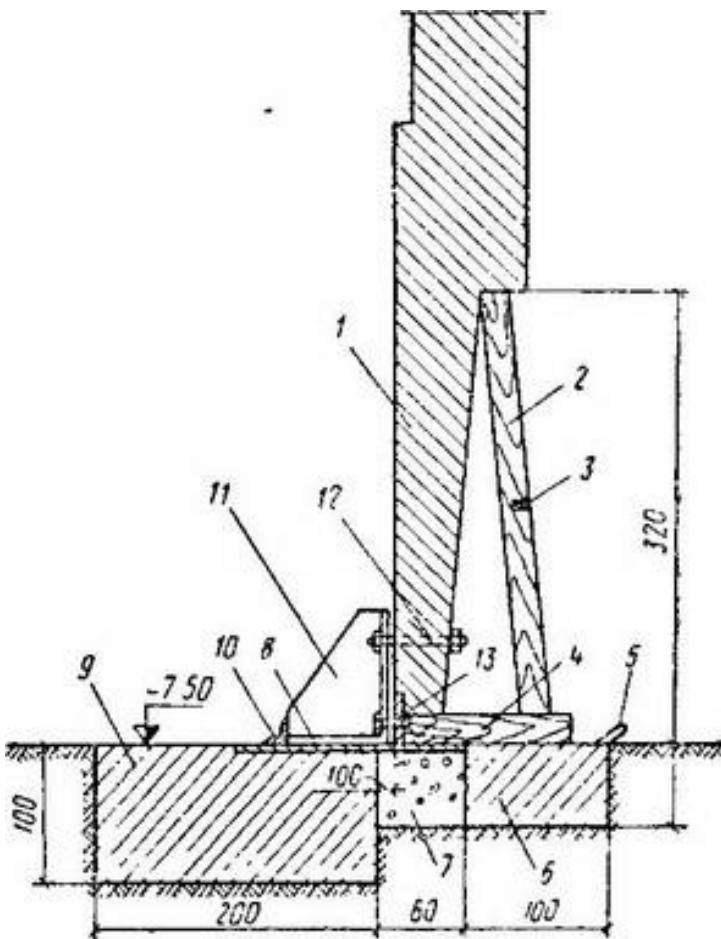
Схема подготовки оснований под нож опускного колодца из сборных железобетонных панелей:
